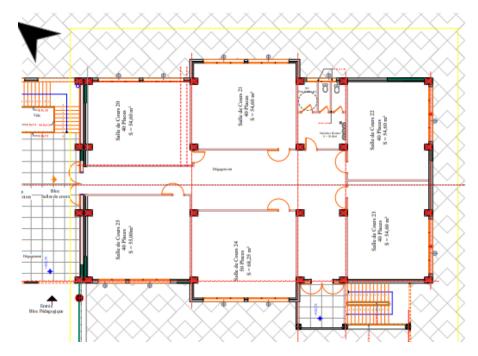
plan des ateliers d'architecture du campus el-kseur Source : BET BART
